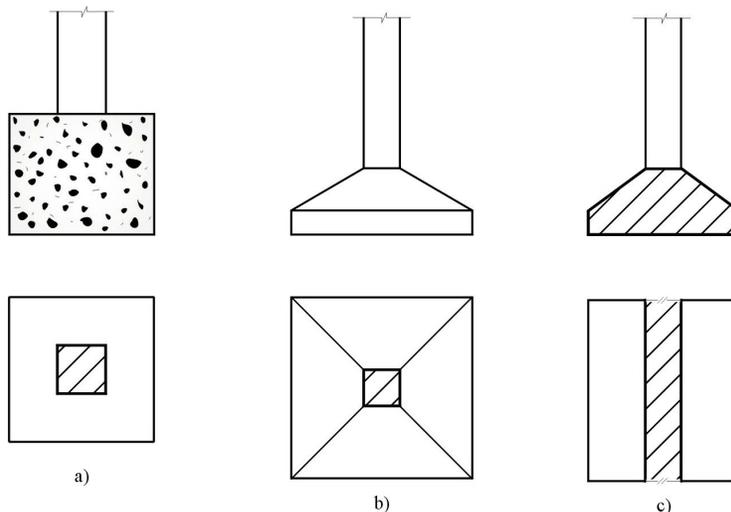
Fundações diretas: a) bloco isolado de concreto ciclópico ou alvenaria de pedra; b) sapata isolada; c) sapata corrida
